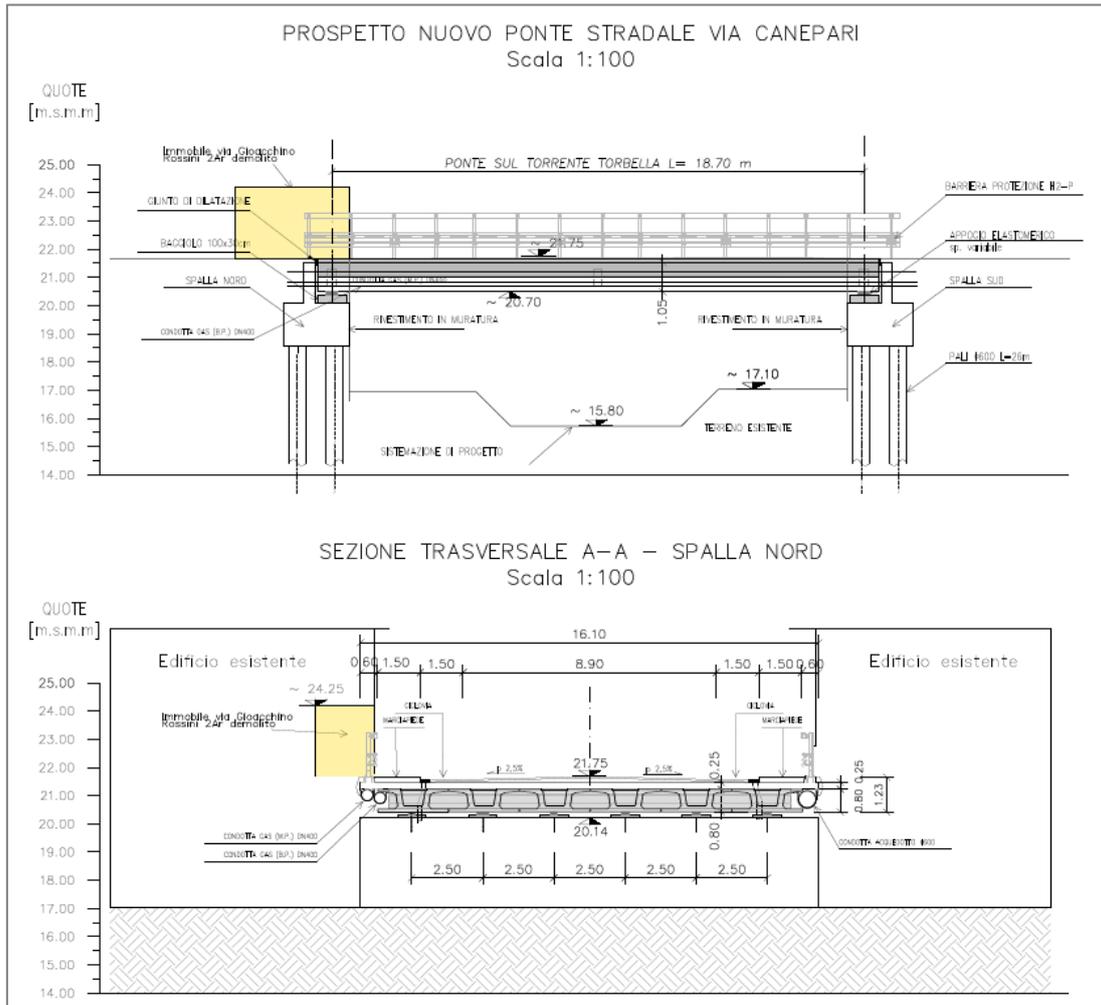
Prospetto (in alto) e sezione trasversale (in basso) del nuovo ponte di via Canepari
